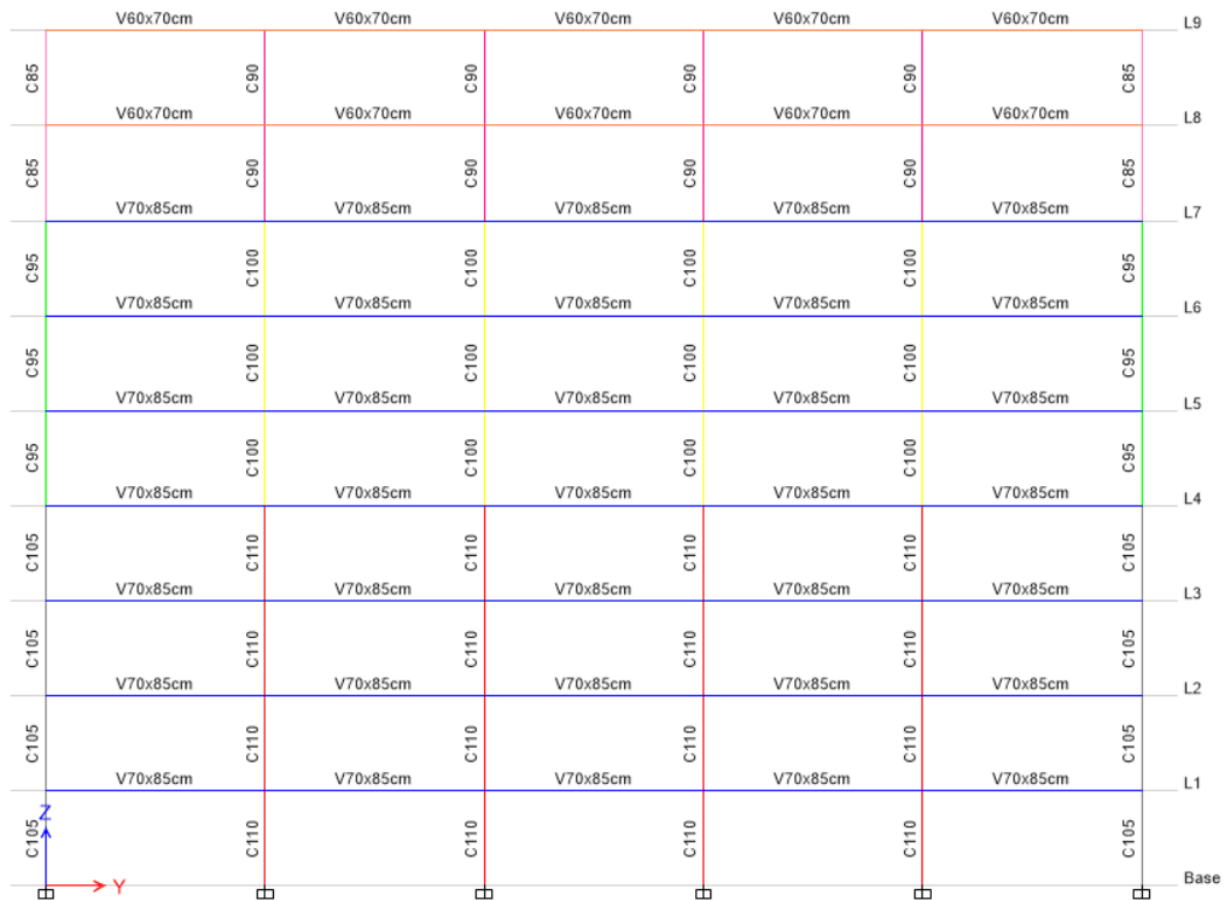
Configuración de un pórtico interior de las secciones para un edificio de 9 pisos.
